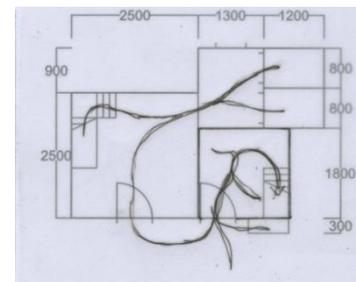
Denah lantai 1 rumah mbak Ai
